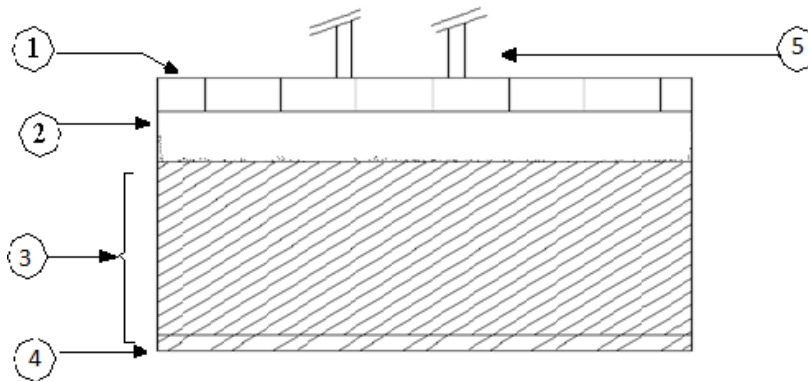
Coupe du plancher étage courant (dalle pleine)
